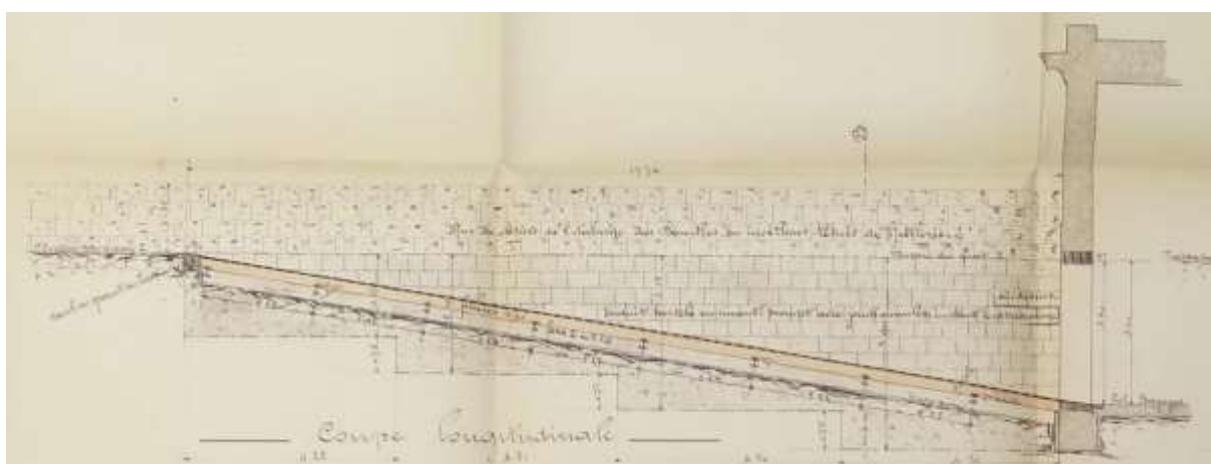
Plan incliné extérieur pour les bagages, coupe, Charles Coigny architecte, 16.4.1909 (ACV K IX 231/1, dossier « Gare de Vevey. Transformation de l'ancien BV »).
